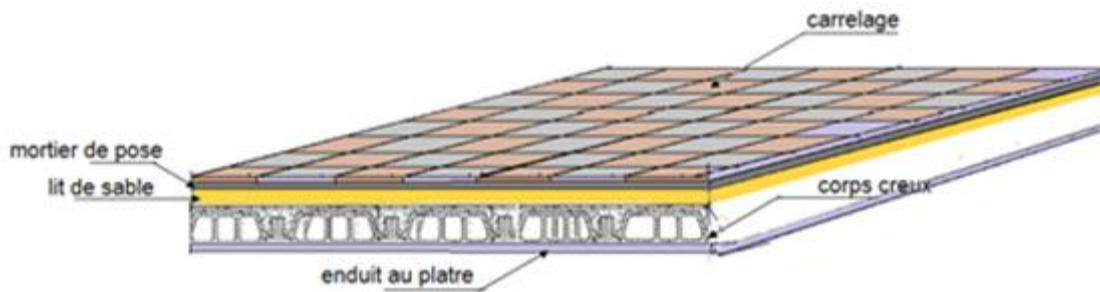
Coupe verticale du plancher courant à corps creux.
